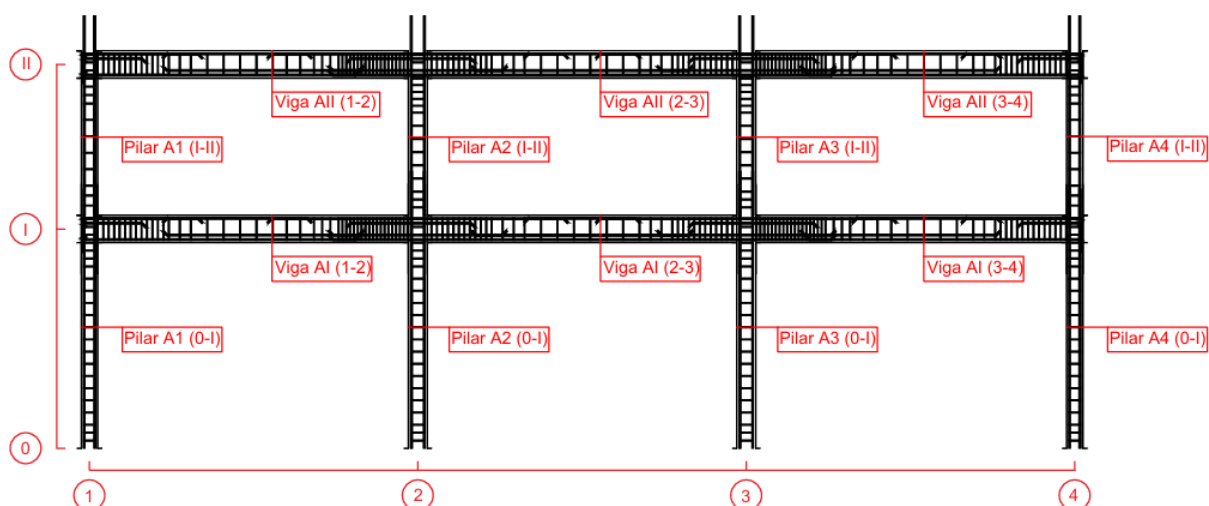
Pormenor de armaduras do 1º e 2º piso do alinhamento A – edifício de 6 pisos
